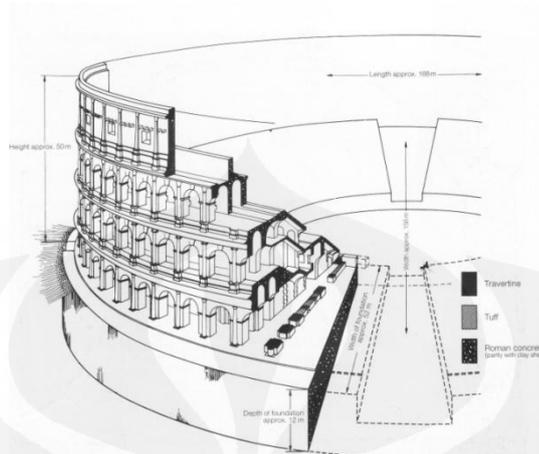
Batang Besi yang Dicampur dalam Konstruksi Batu dan Beton Romawi,
